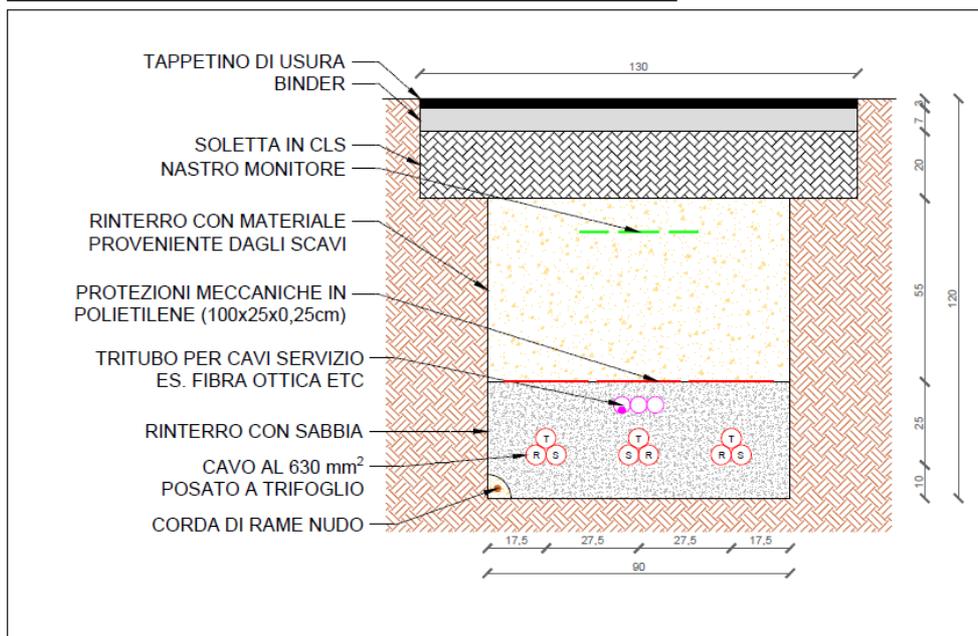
Sezione tipo di posa cavidotto M.T. su Strade Comunali
